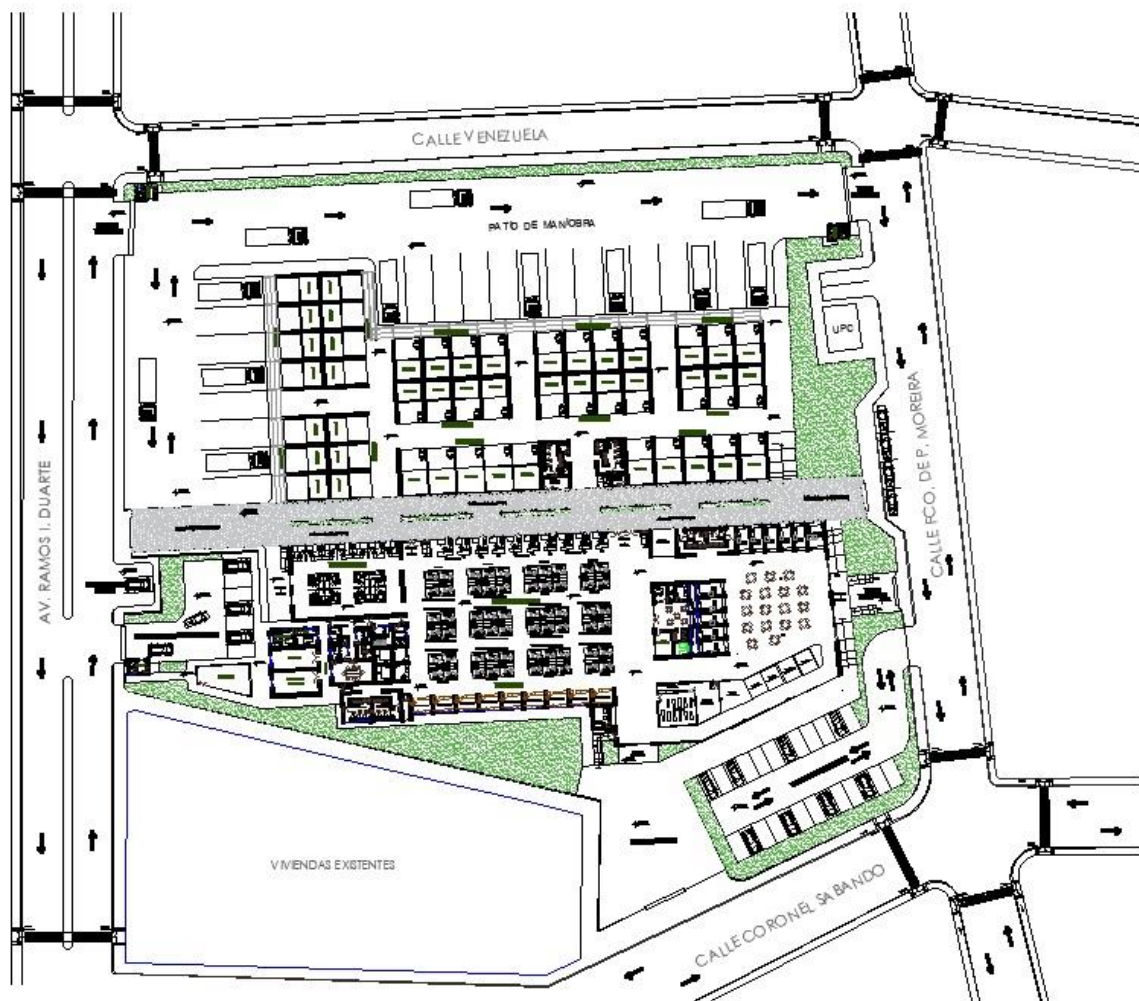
, Planta Arquitectónica de la nueva propuesta del Mercado N° 2 de Portoviejo.
